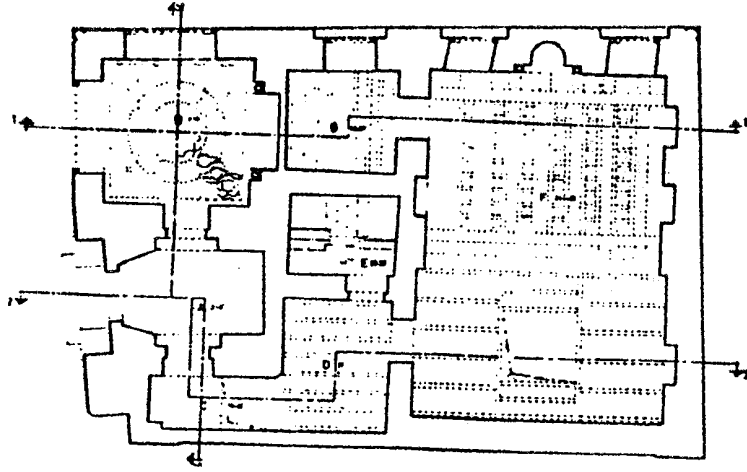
مسقط أفقي لبداستان (منشأة تجارية) في استانبول (عن : Cezar)
